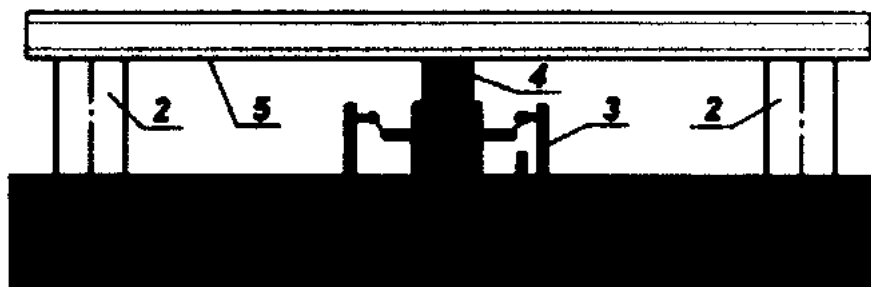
Установка с гидравлическим домкратом, системой балок и анкерными сваями [26]
